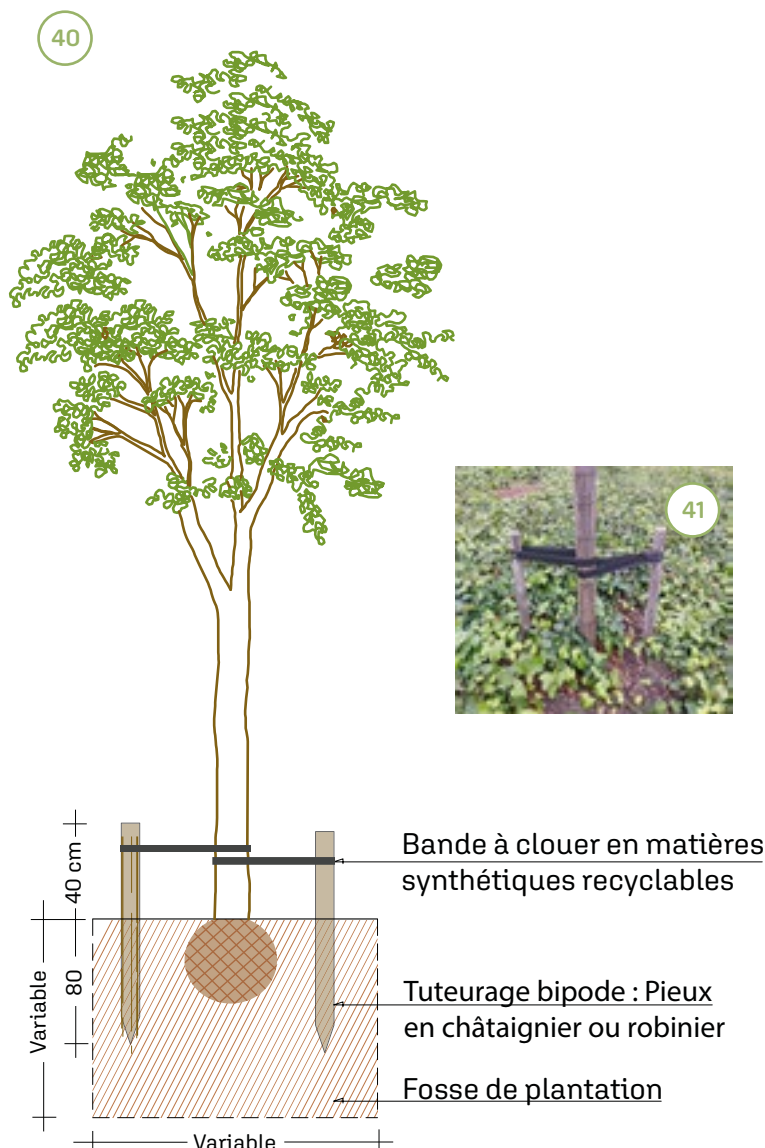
Coupe technique de tuteurage d'arbres plantés en bosquet
